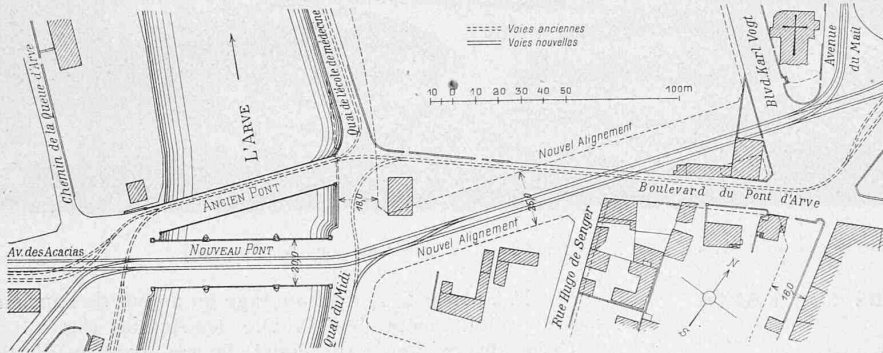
Plan de situation de l'ancien et du nouveau pont. — Echelle 1 : 3000.
